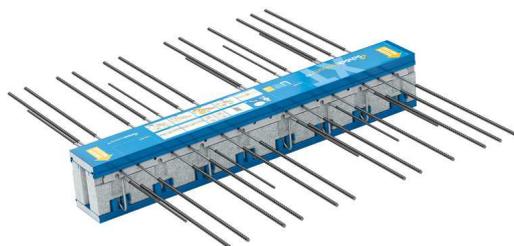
giunto isolante Isokorb®, prodotto dall'azienda Schöck
